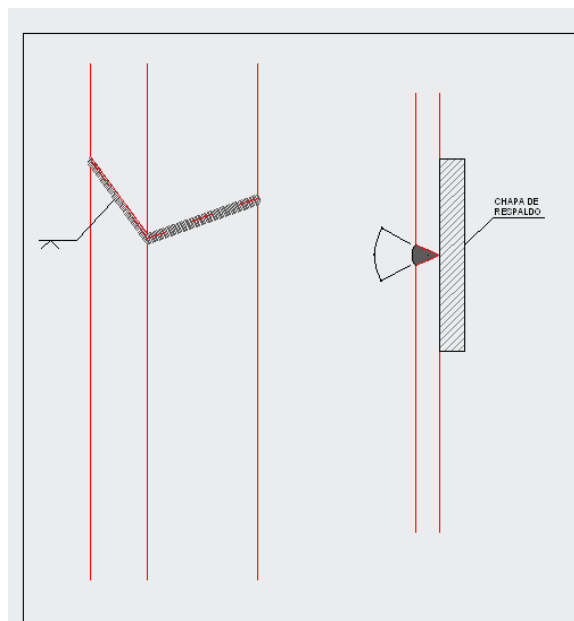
UNION SOLDADA EN OBRA
